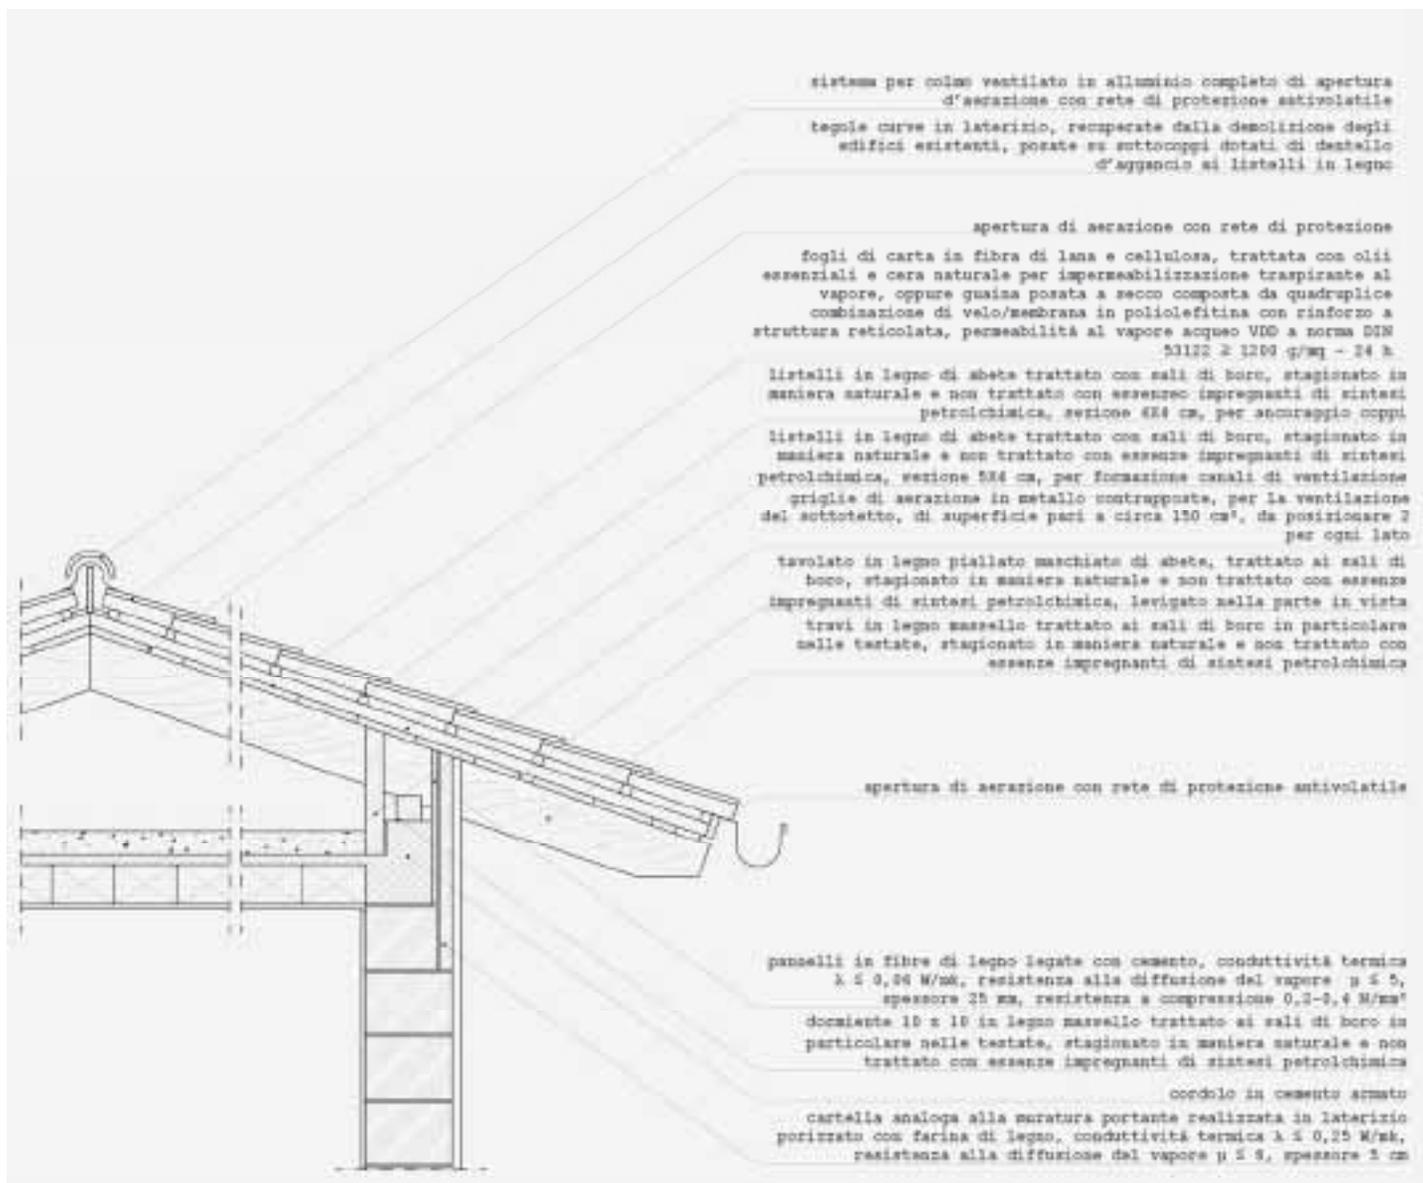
Schema copertura e sottotetto ventilato proposto nel progetto esecutivo.
